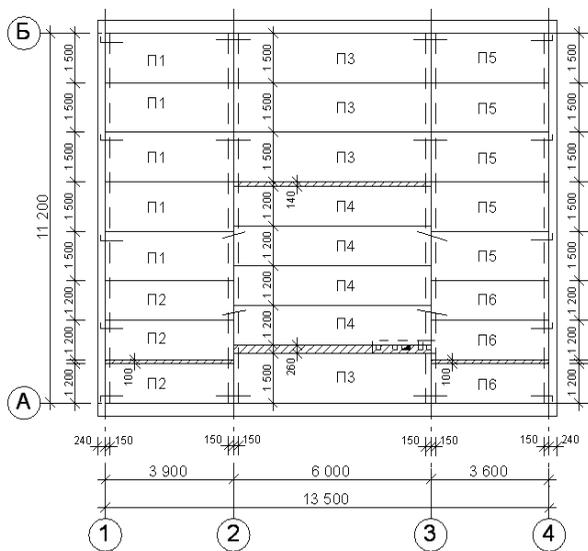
Пример оформления плана сборного железобетонного перекрытия
